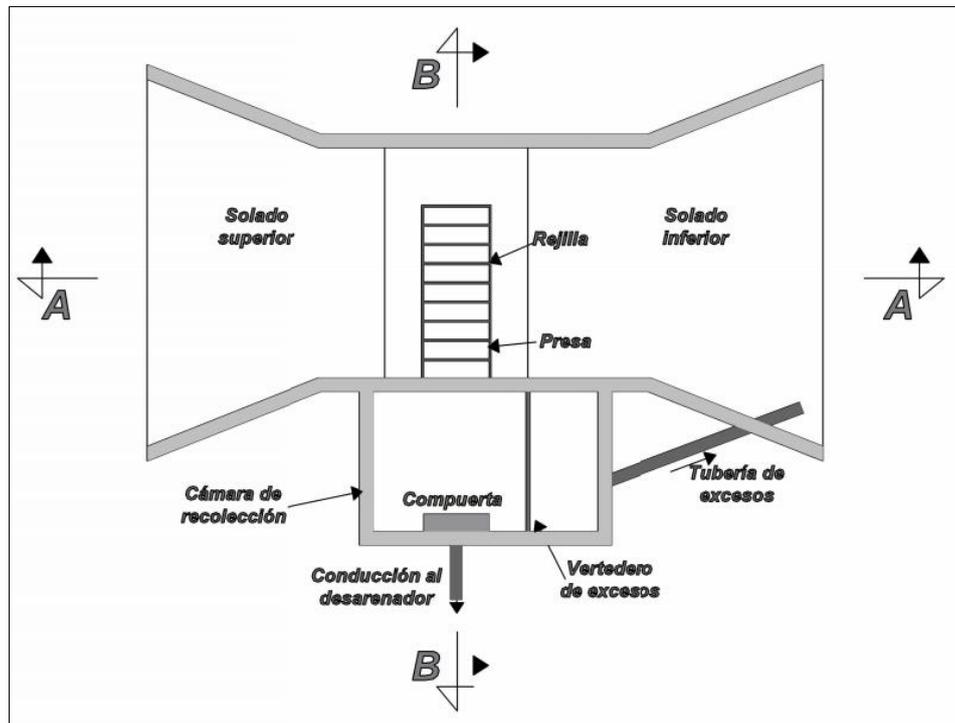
Vista en planta de un sistema de captación tipo azud con rejilla de fondo. – Fuente: (López Cualla, 2003)
